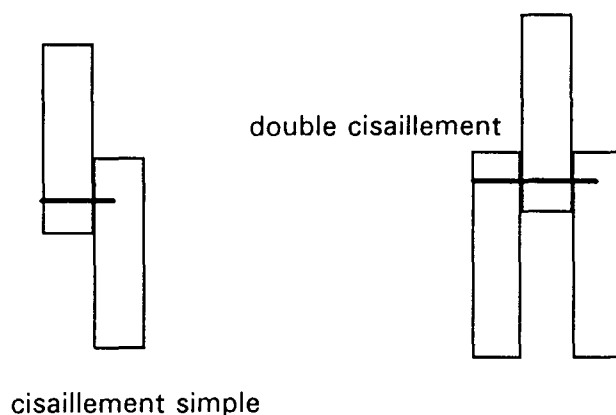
Plans de cisaillement des organes d'assemblage par tige
